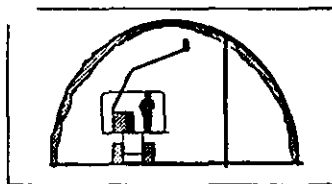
Aplicación de concreto reforzado con 60 kg/m^3 de fibras de acero.
